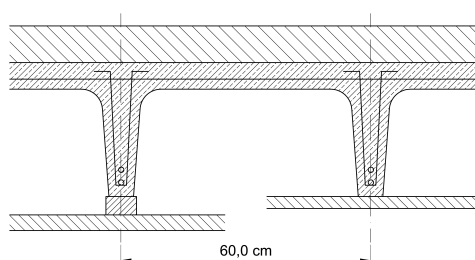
Stahlbetonrippendecke mit Füllkörper [36]
